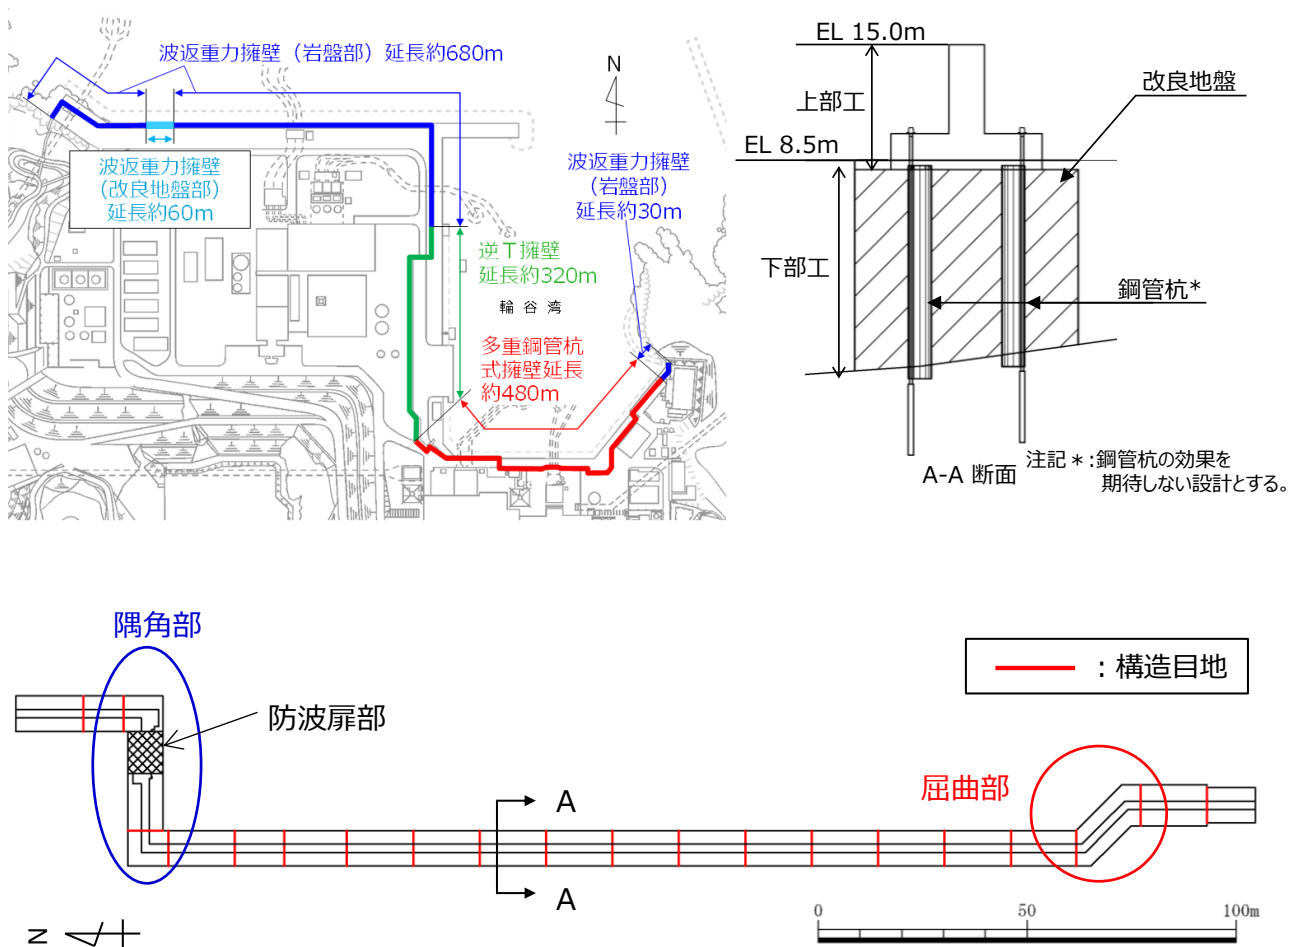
防波壁（逆T擁壁）の構造目地（平面図）
